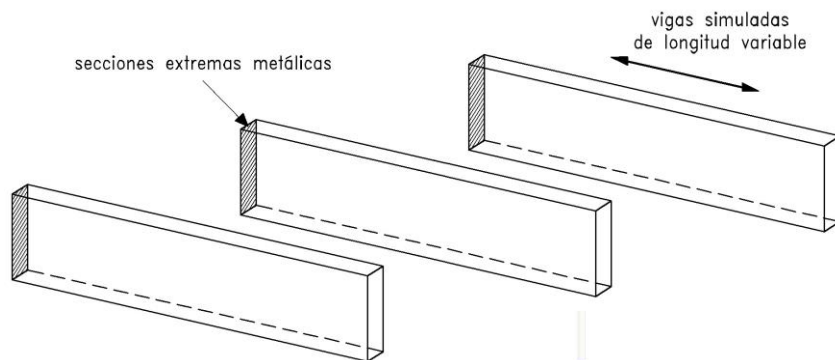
Vigas simuladas de sección rectangular y longitud variable (sistema telescópico)
